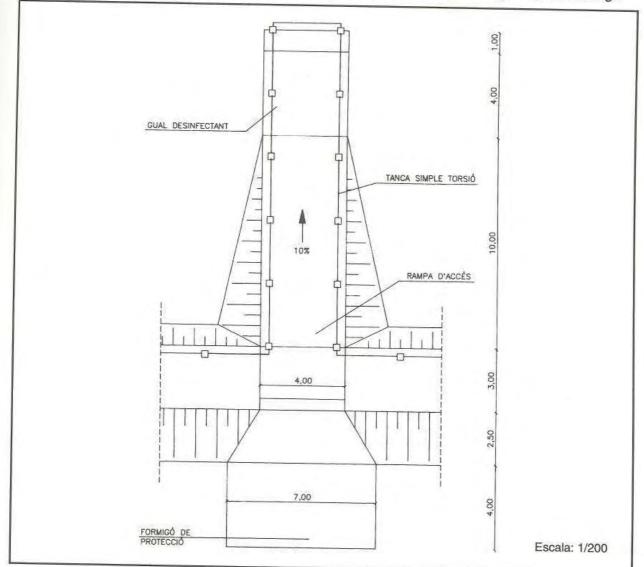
Planta de la rampa i de la zona de treball del moll de càrrega i de descàrrega
